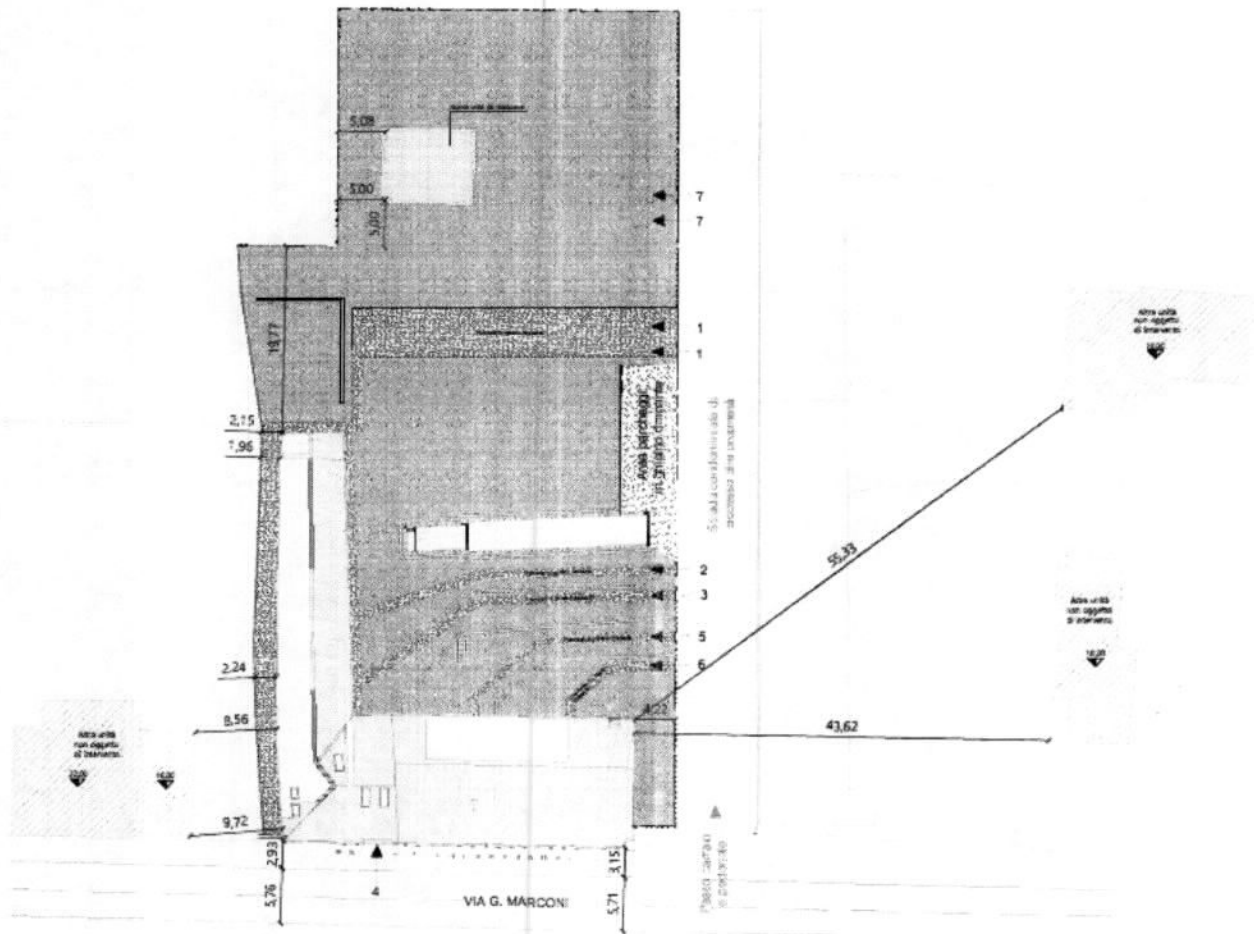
Estratto della tavola progettuale All.07 - SDP
